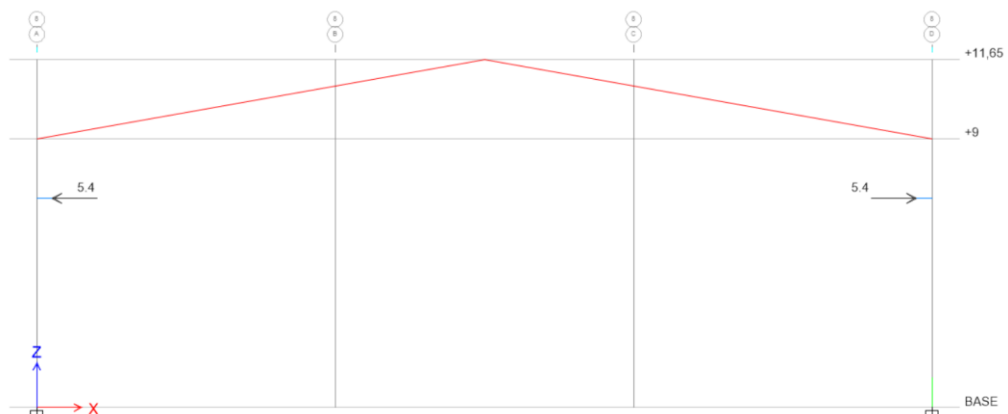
Berat Sendiri Runway Beam, Backing Truss, dan Ring Beam
